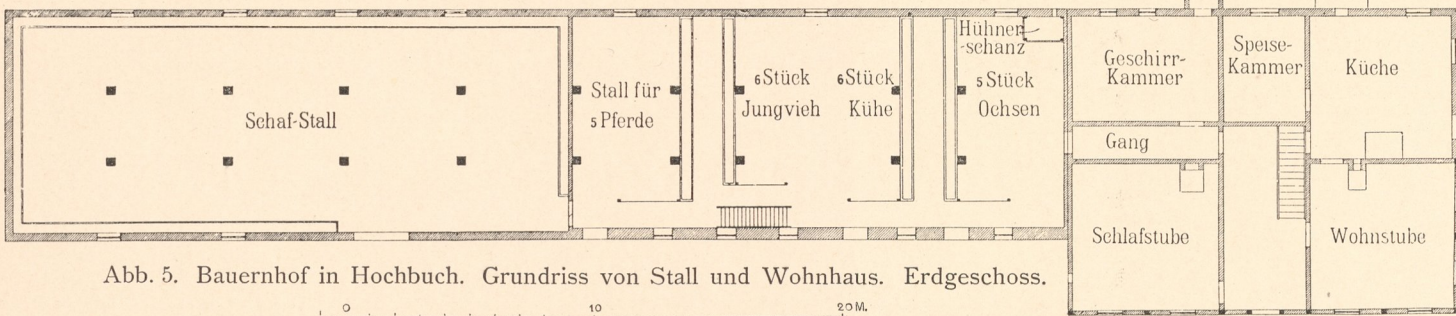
Bauernhof in Hochbuch. Grundriss von Stall und Wohnhaus. Erdgeschoss.
